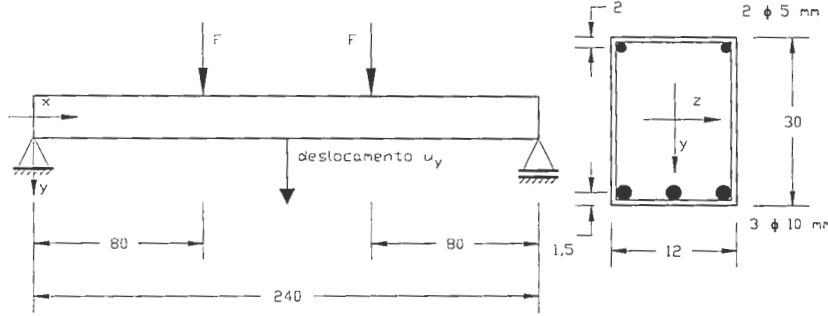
Viga em concreto armado - geometria e detalhe de armaduras - medidas em cm
